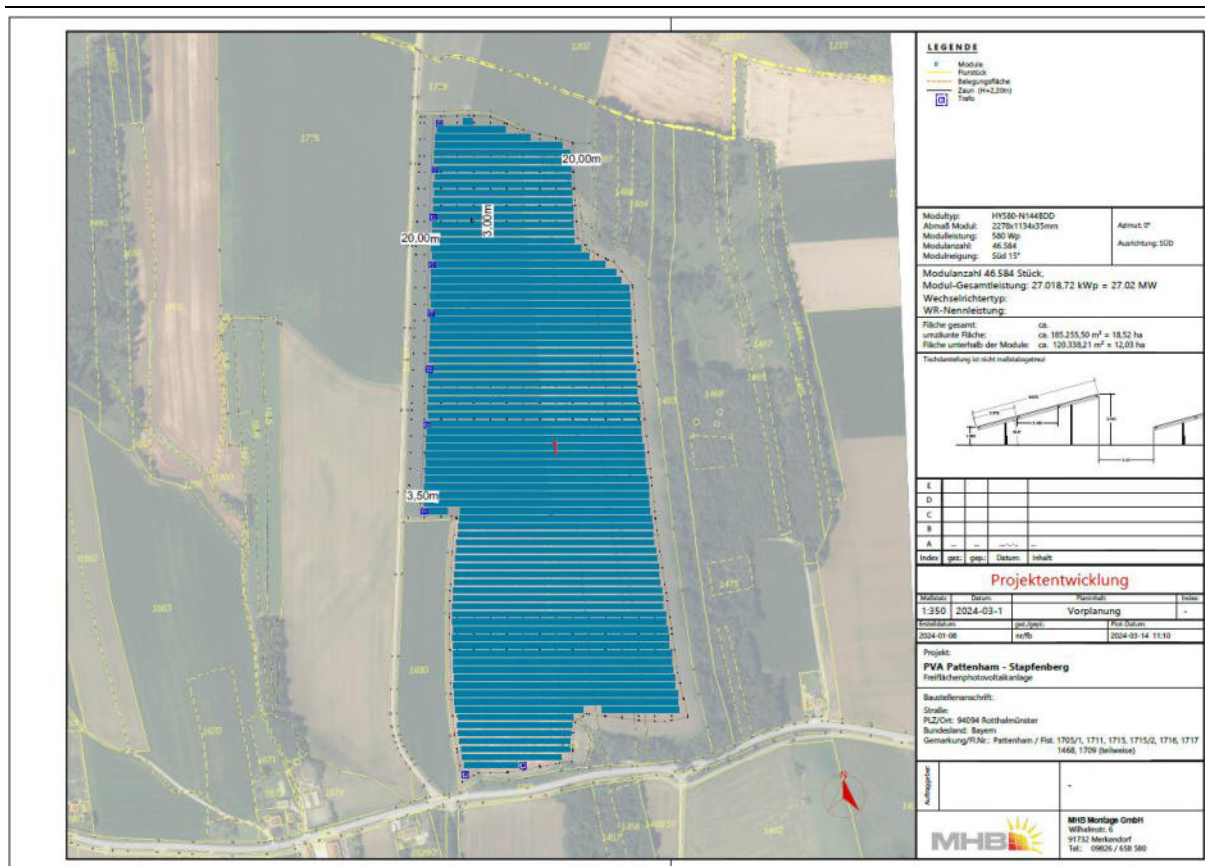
Vorplanung zum Belegungsplan der PV-Anlage Pattenham - Stapfenberg. Erstellt durch MHB (2024), Stand 01.03.2024.
